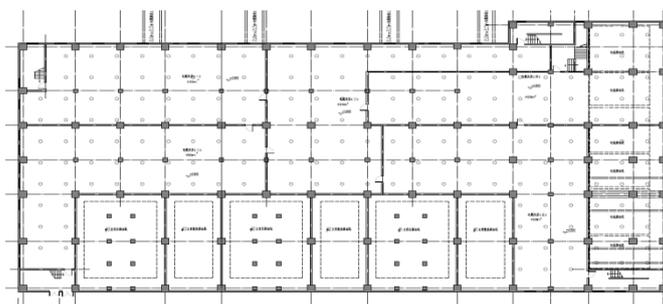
TJ-220-A2-4 方案电缆夹层悬挂式超细干粉平面布置图
